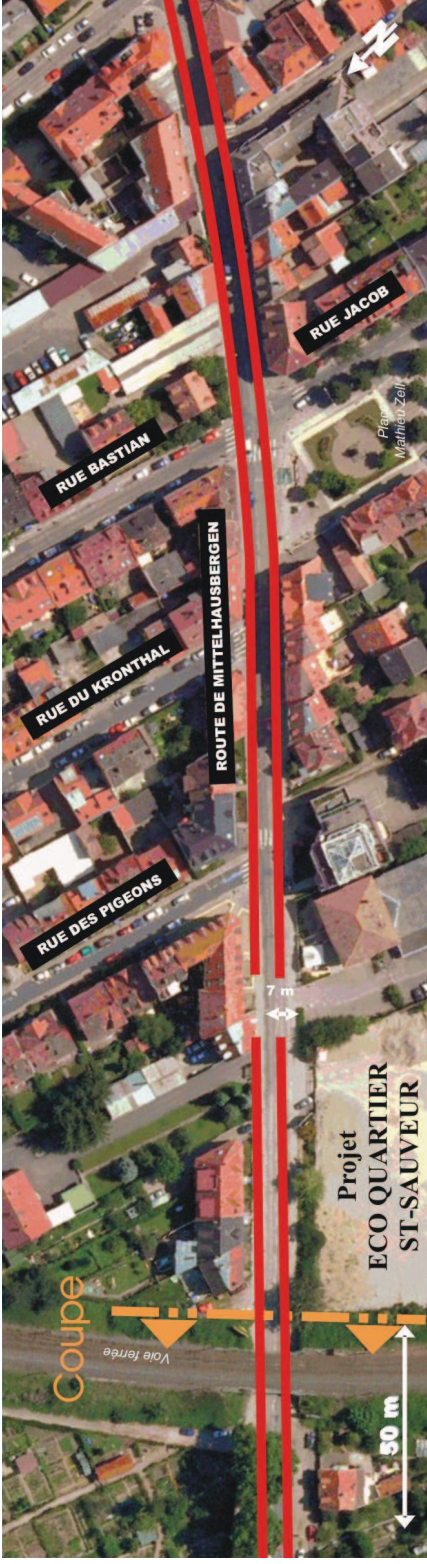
Point dur d'insertion de la variante 5 (pont sur la rocade ferroviaire Ouest)
